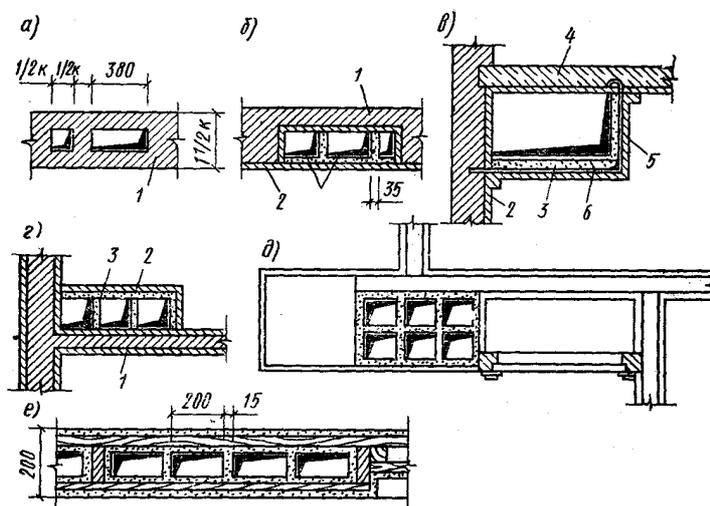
Конструкция вентиляционных каналов: а – в кирпичных стенах; б – в бороздах стены, заделываемых плитами; в – подвесной воздуховод у потолка; г – приставные вертикальные каналы; д – компоновка каналов со встроенными шкафами; е – каналы из сухой штукатурки в перегородках: 1 – кирпичные стены; 2 – штукатурка; 3 – гипсошлаковые плиты; 4 – перекрытие; 5 – подвеска стальная; 6 – крепление (50×50×4 мм)
